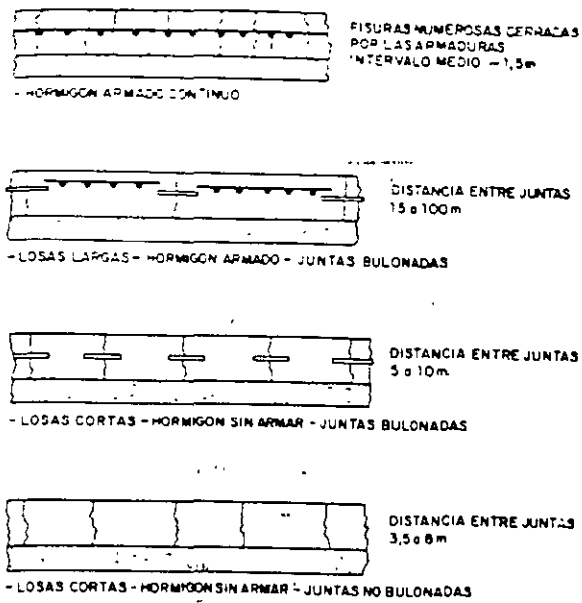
Principales estructuras utilizadas en calzadas de hormigón a lo largo del tiempo.
